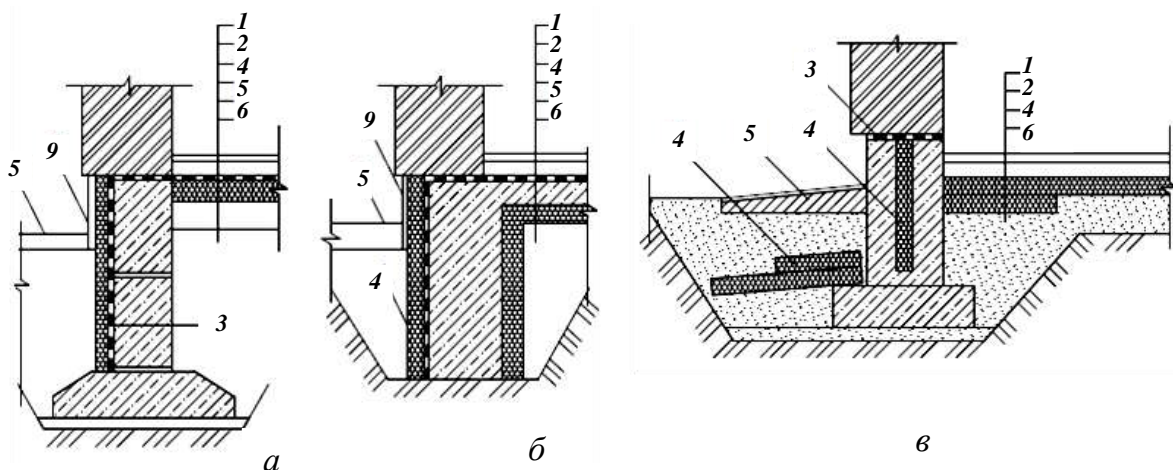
Тепло- і гідроізоляція фундаментів неглибокого закладання будівель без підвалів:
